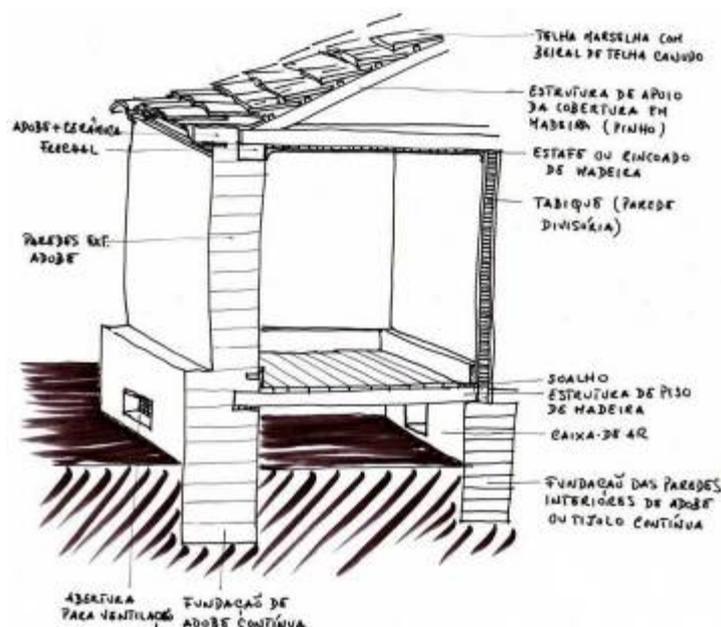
Esquema de sistema construtivo tradicional de adobe – A
